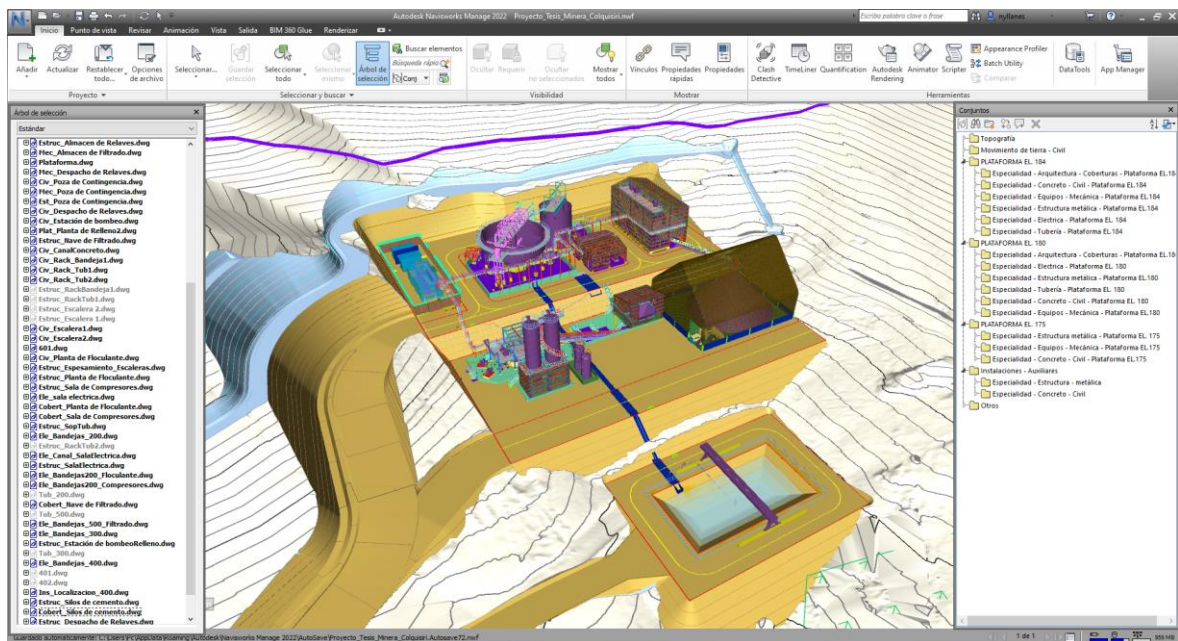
Especialidad de concreto, estructura metálica, equipos mecánicos y Eléctrica.
